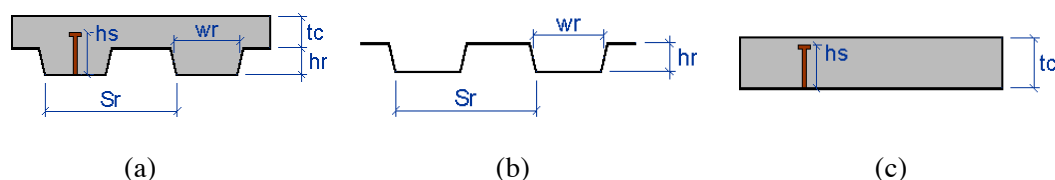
Tipos de secciones de los elementos tipo cobertura (a) Cobertura rellena. (b) Cobertura sin rellenar. (c) Losa maciza (Fuente: Taboada y De Izcue, 2009)
